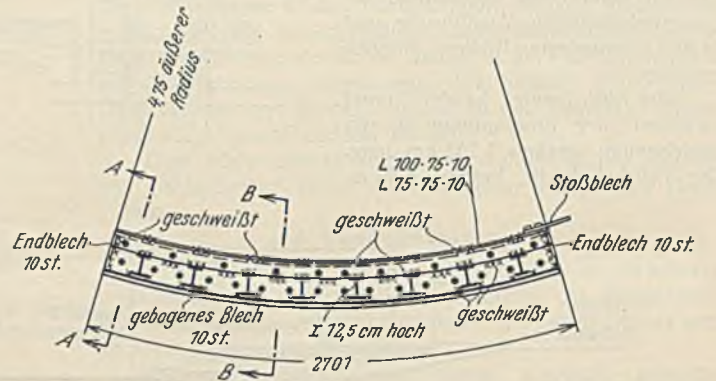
Verkleidung des inneren Tunnelmantels aus gepreßtem Eisenblech nach dem Lichtbogenschweißverfahren hergestellt.
